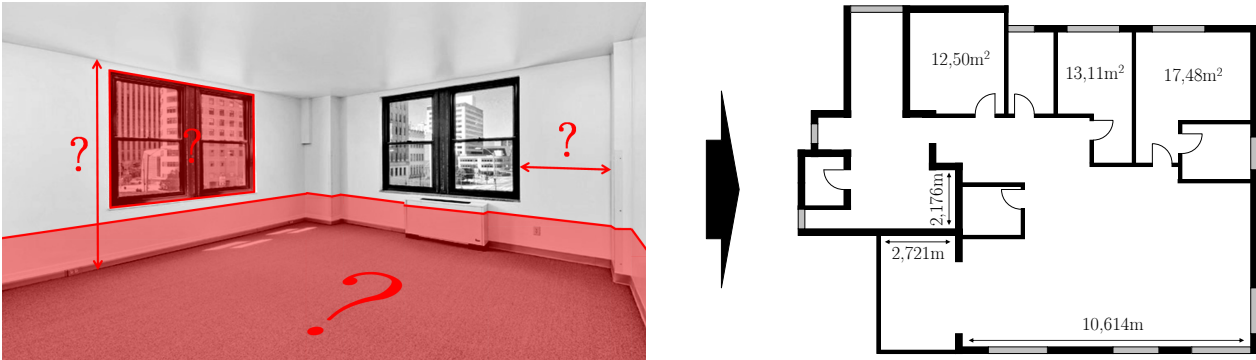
Beispiel einer Modellbildung in Form eines Grundrissplans mit Längen- und Flächenmaßen [7]
